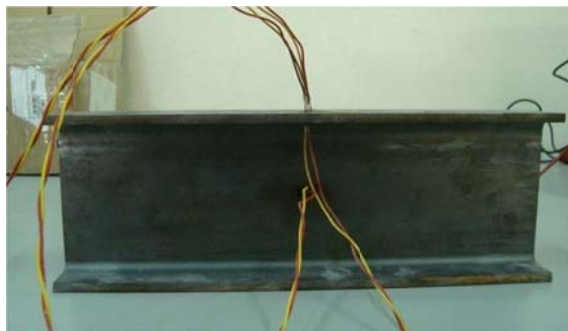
Processo de soldadura de termopares no elemento estrutural.
